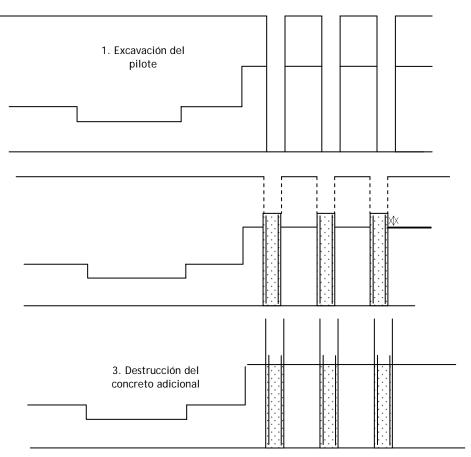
A - Detalle Constructivo para Pilotes que no llegarán a la Superficie
